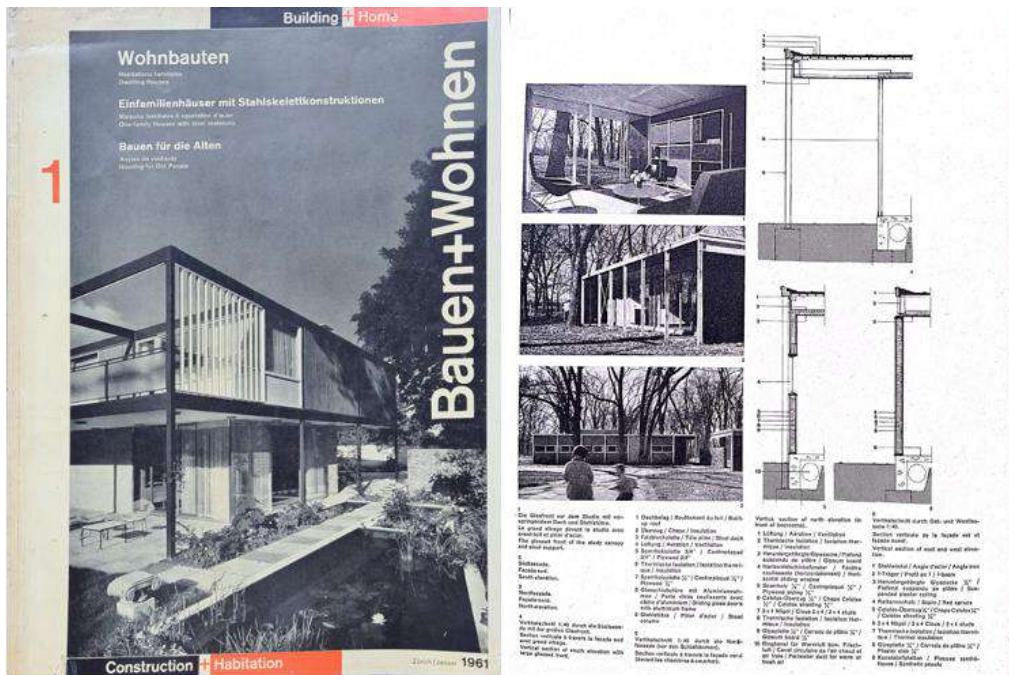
Revista *Bauen+Wohnen*, n. 01, jan., 1961. Capa e folha de detalhe construtivo.
